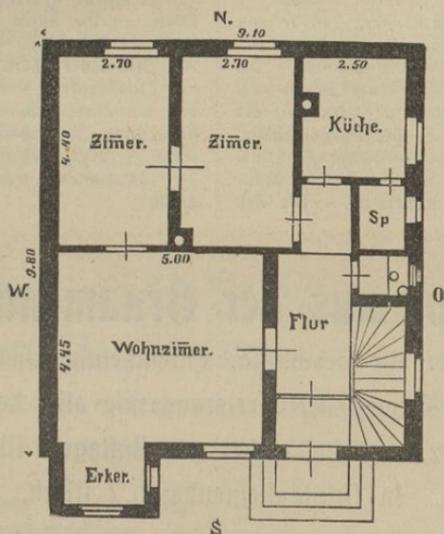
(Grundriss). Wohnhaus für eine Familie.
